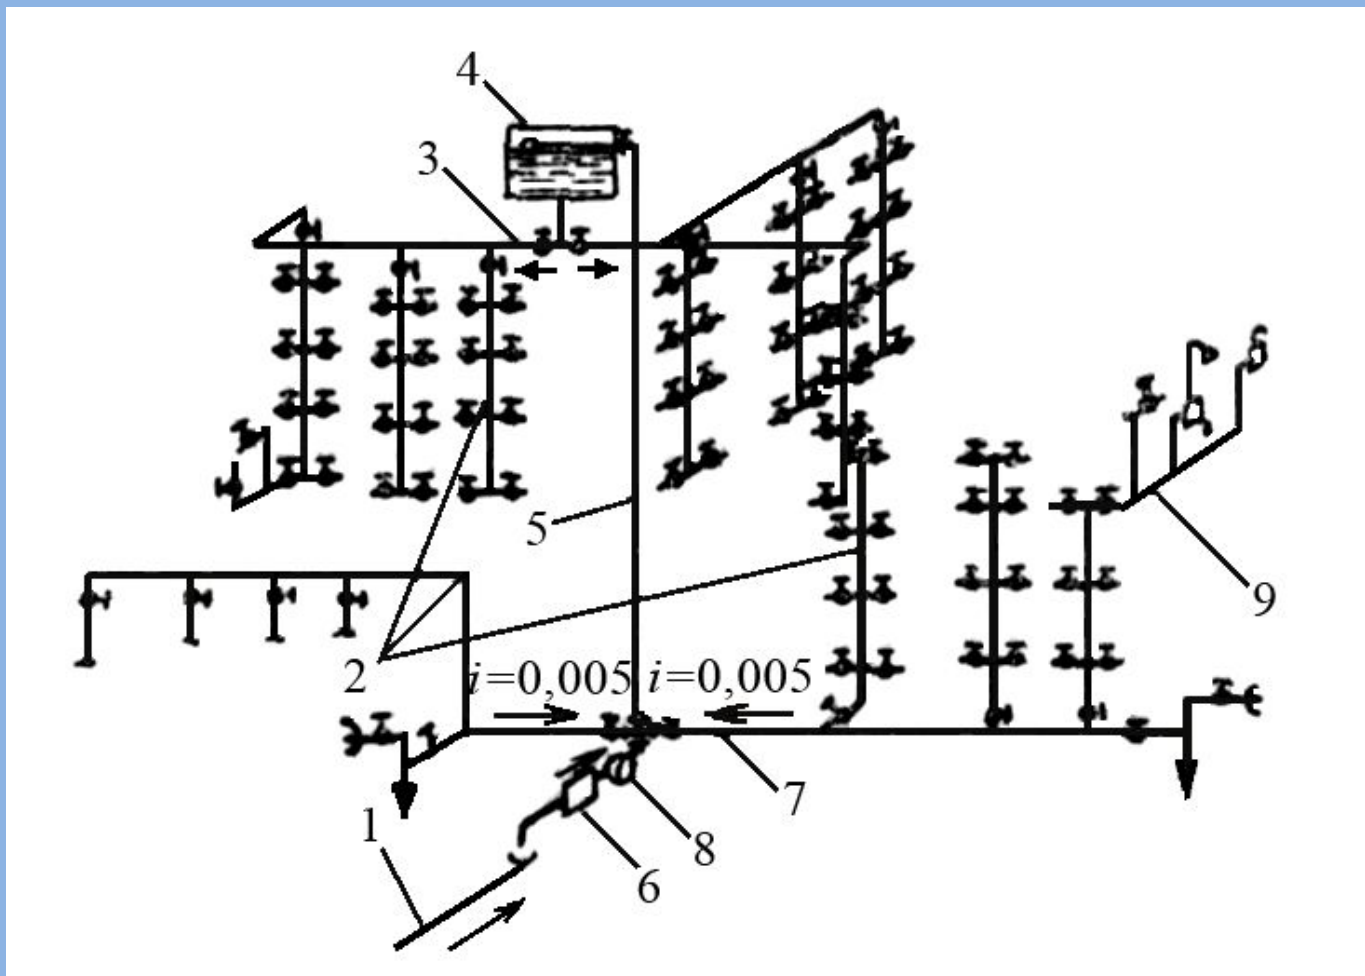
Система водоснабжения здания с водонапорным баком: 1 – ввод; 2 – распределительные трубопроводы; 3 – верхняя магистраль; 4 – водонапорный бак; 5 – подающий трубопровод; 6 – водомерный узел; 7 – нижняя магистраль; 8 – обратный клапан; 9 – подводка
